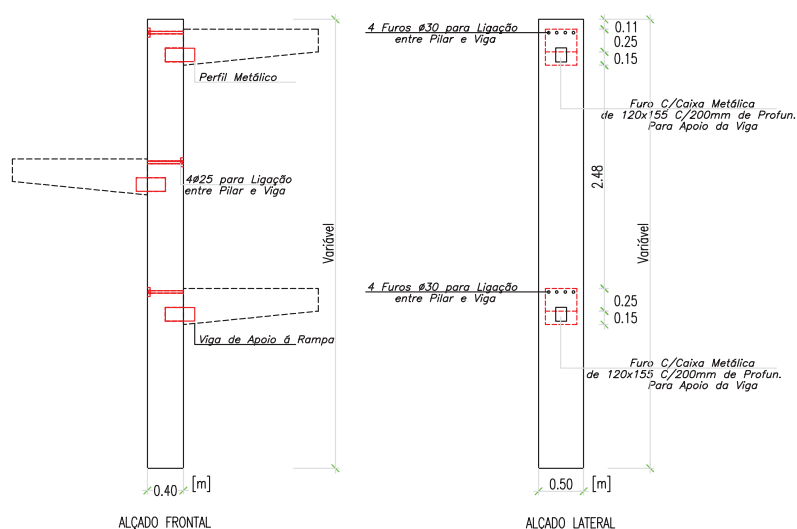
Alçado do pilar das rampas sem continuidade das vigas [62]
